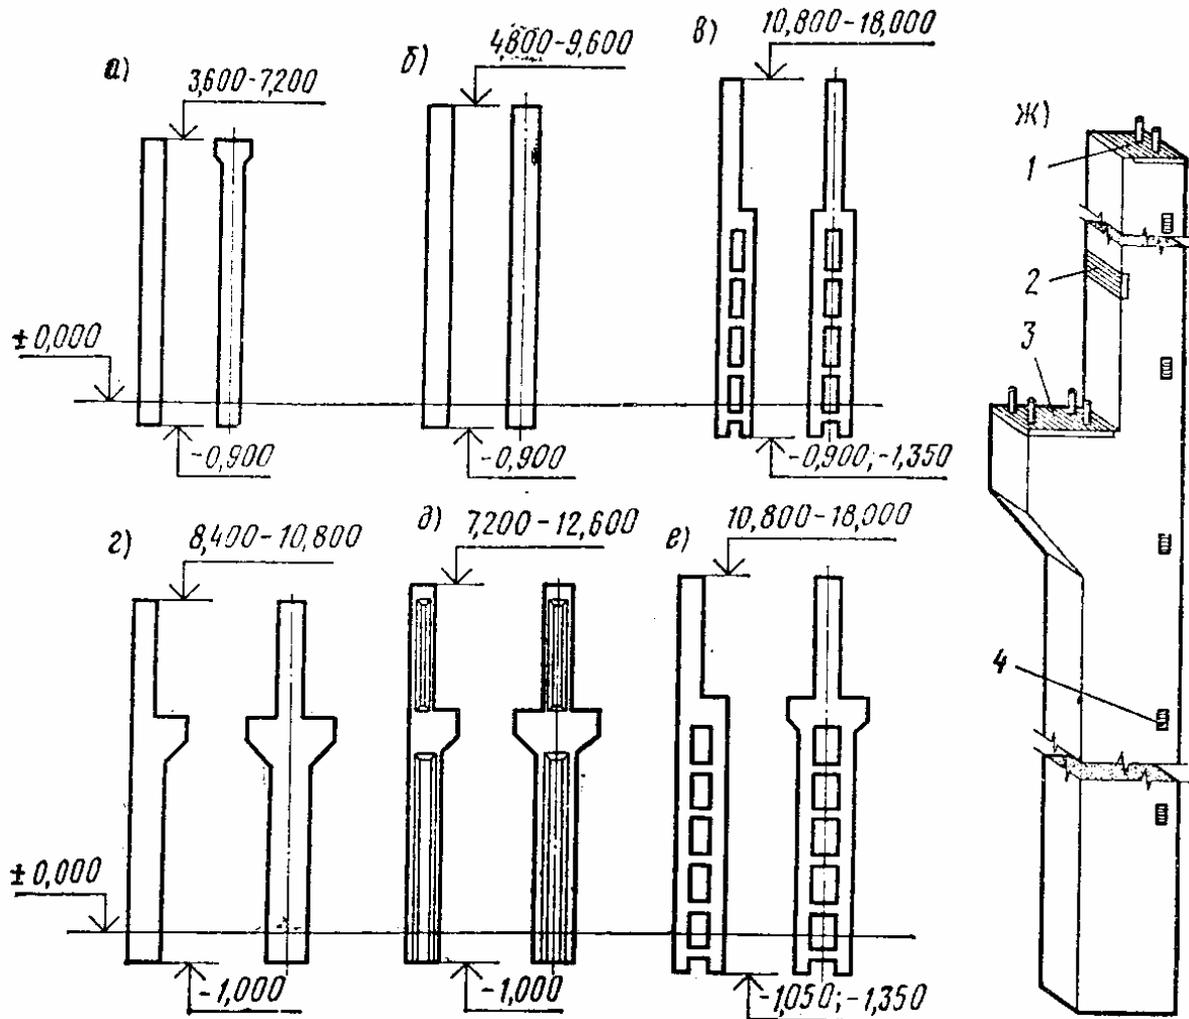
Железобетонные колонны одноэтажных промышленных зданий:
